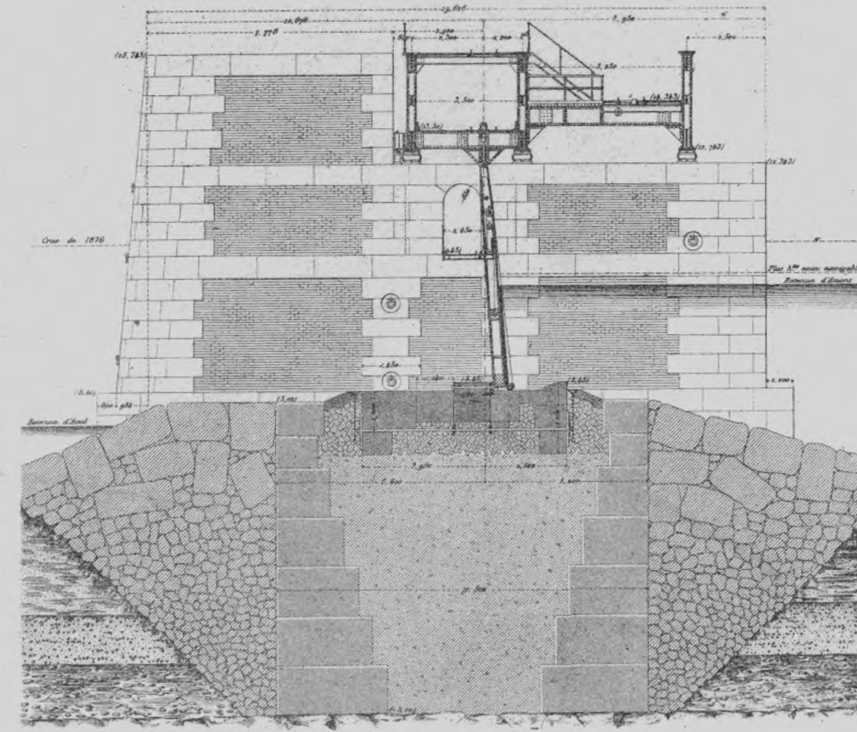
Coupe d'une passe déversoir s: MN et Elevation de la pile N°3.
